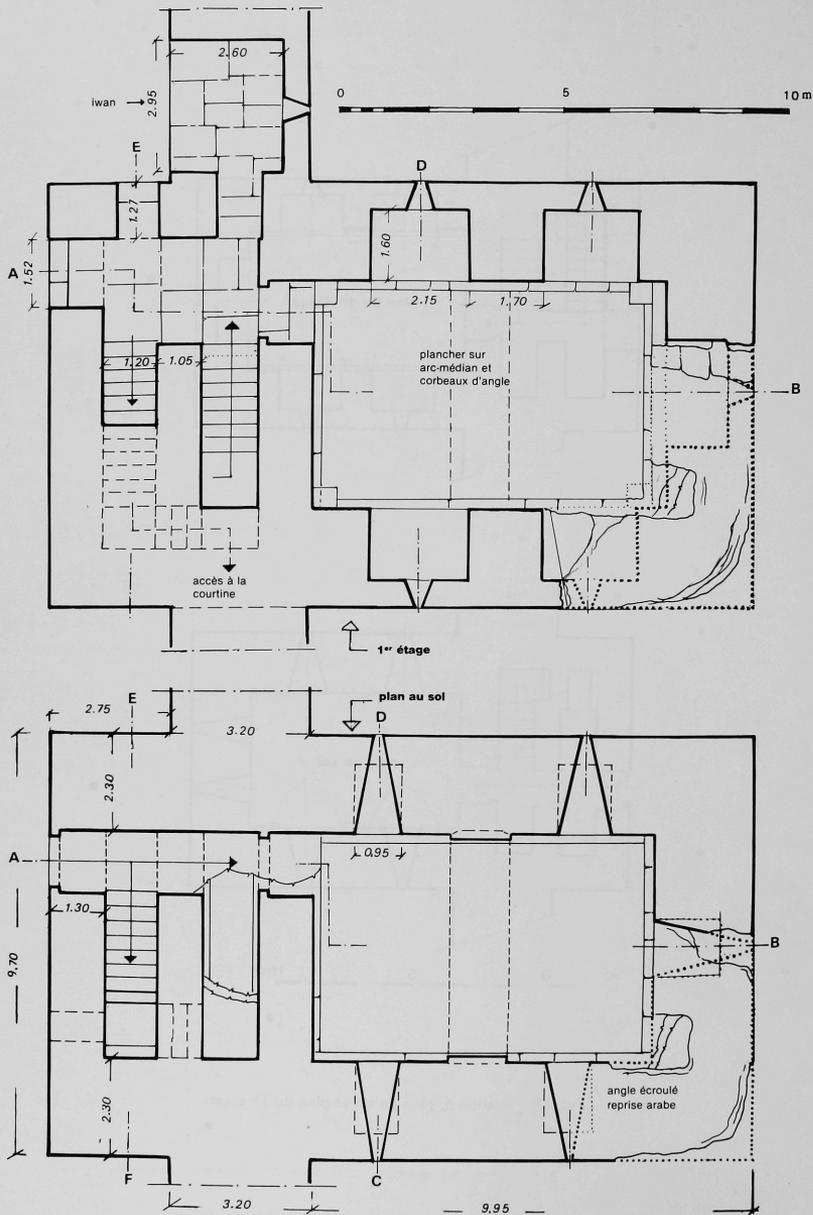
Bastion 6, plan au sol et plan du 1^{er} étage.
